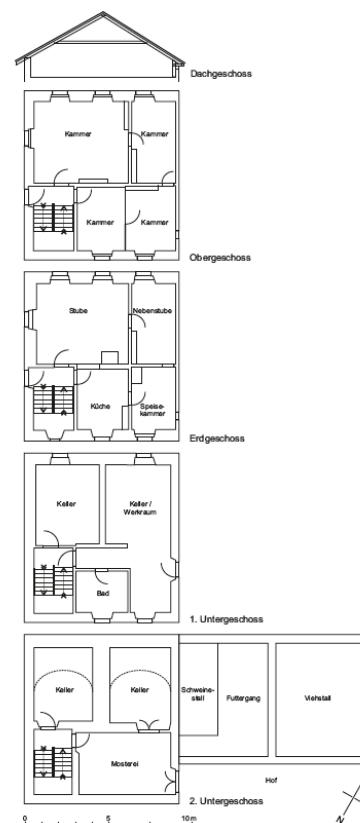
Grundrisse und Querschnitt 1:200.
